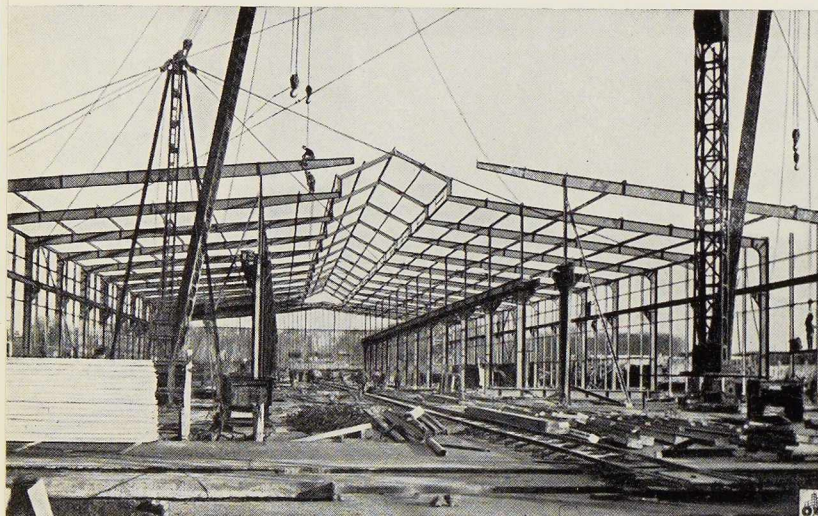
Halle n° 8 de la Foire de Hanovre. Constructeur C. H. Jucho, Dortmund.
